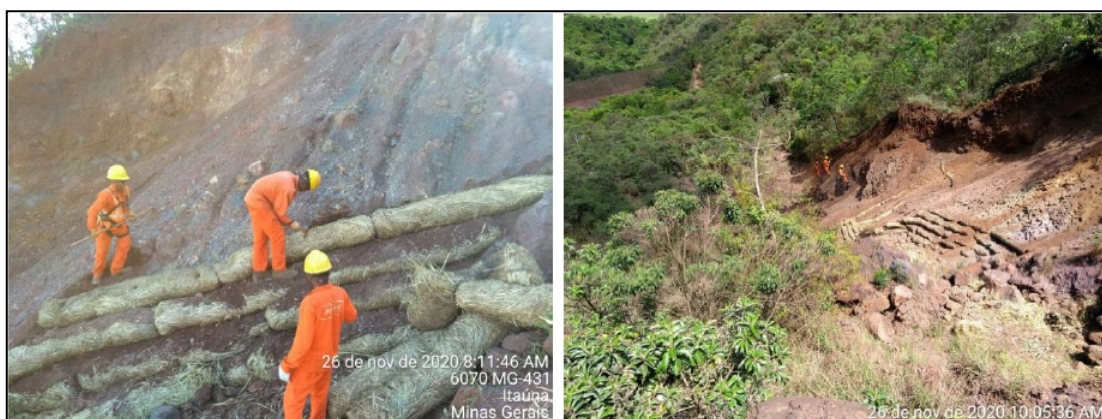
Ponto 04 - Construção da paliçada com bermalonga.
